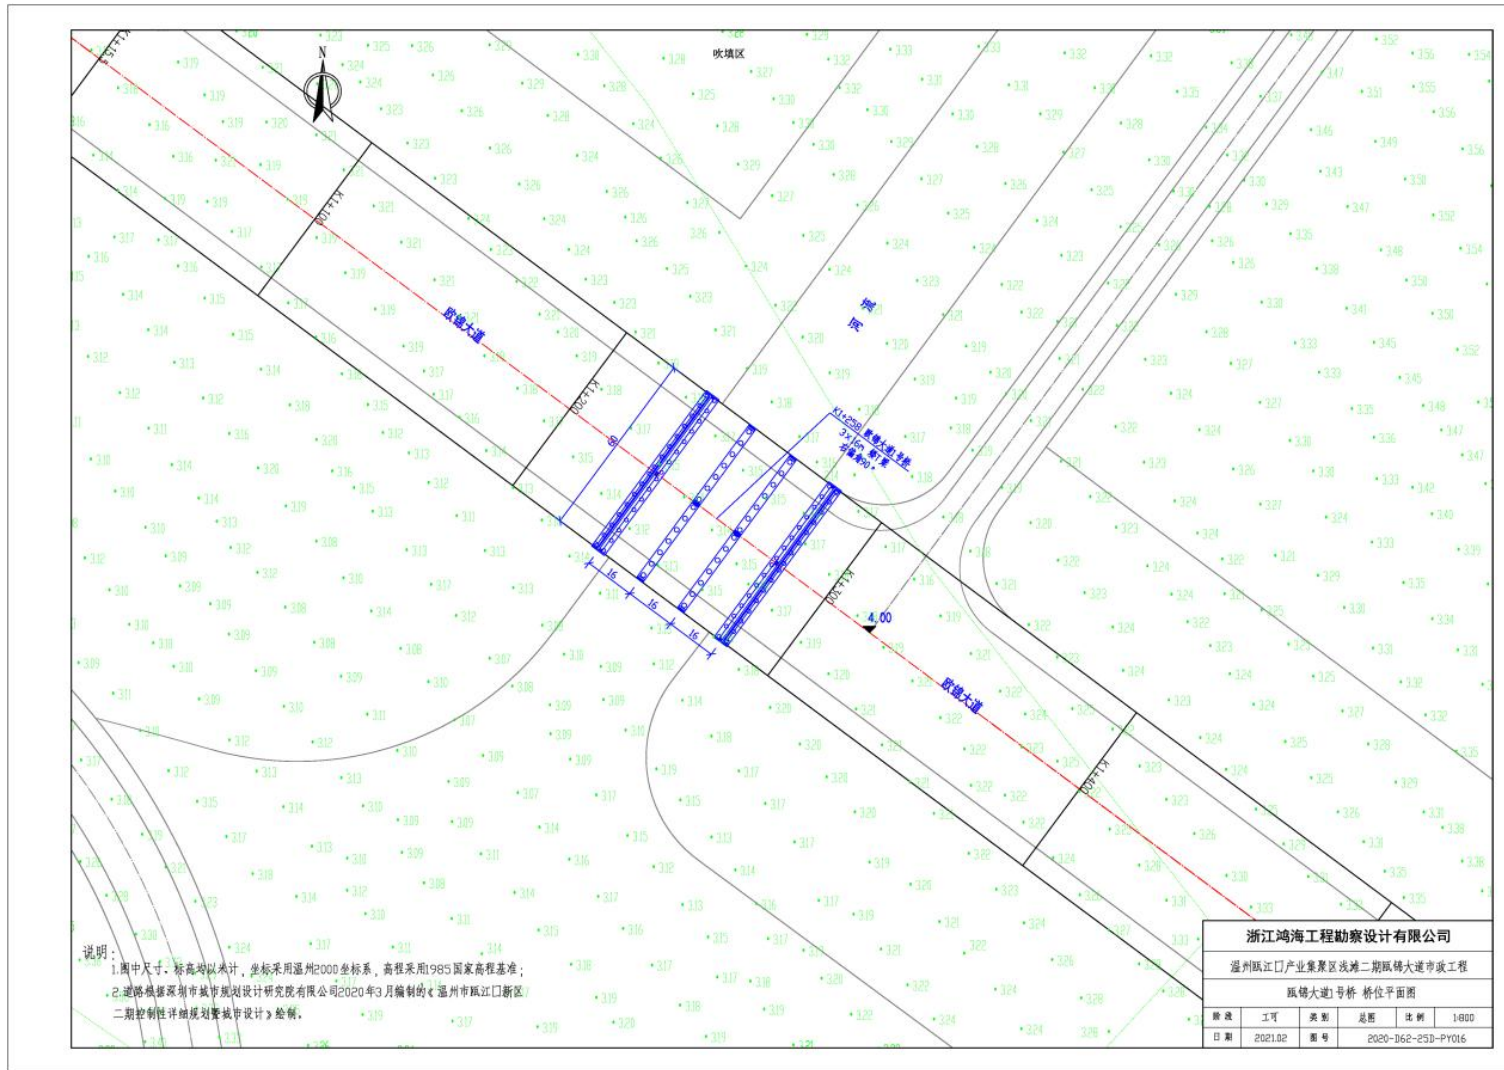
瓯锦大道 1 号桥桥位平面图
